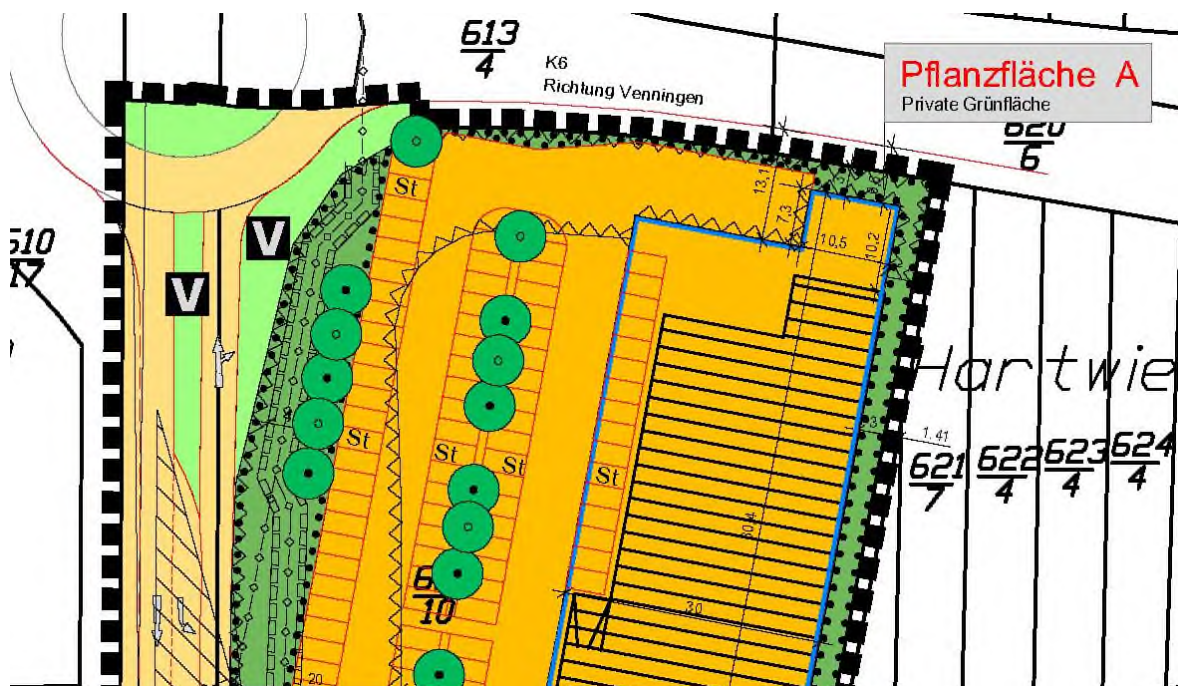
Planausschnitt 1. Änderung (Änderung des Baufensters)
